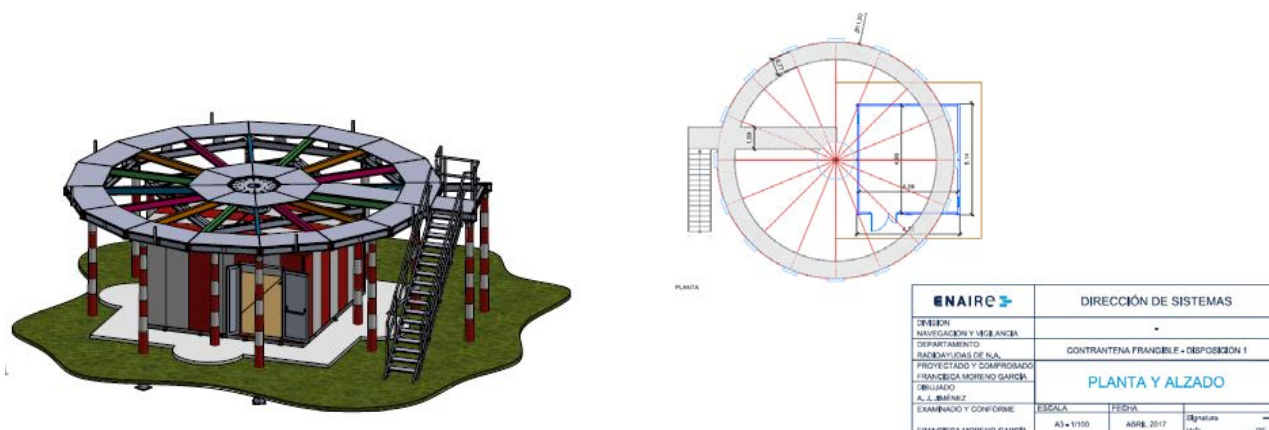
Instalación el nuevo edificio VOR con su contraantena frangible. Fuente: Proyecto constructivo
